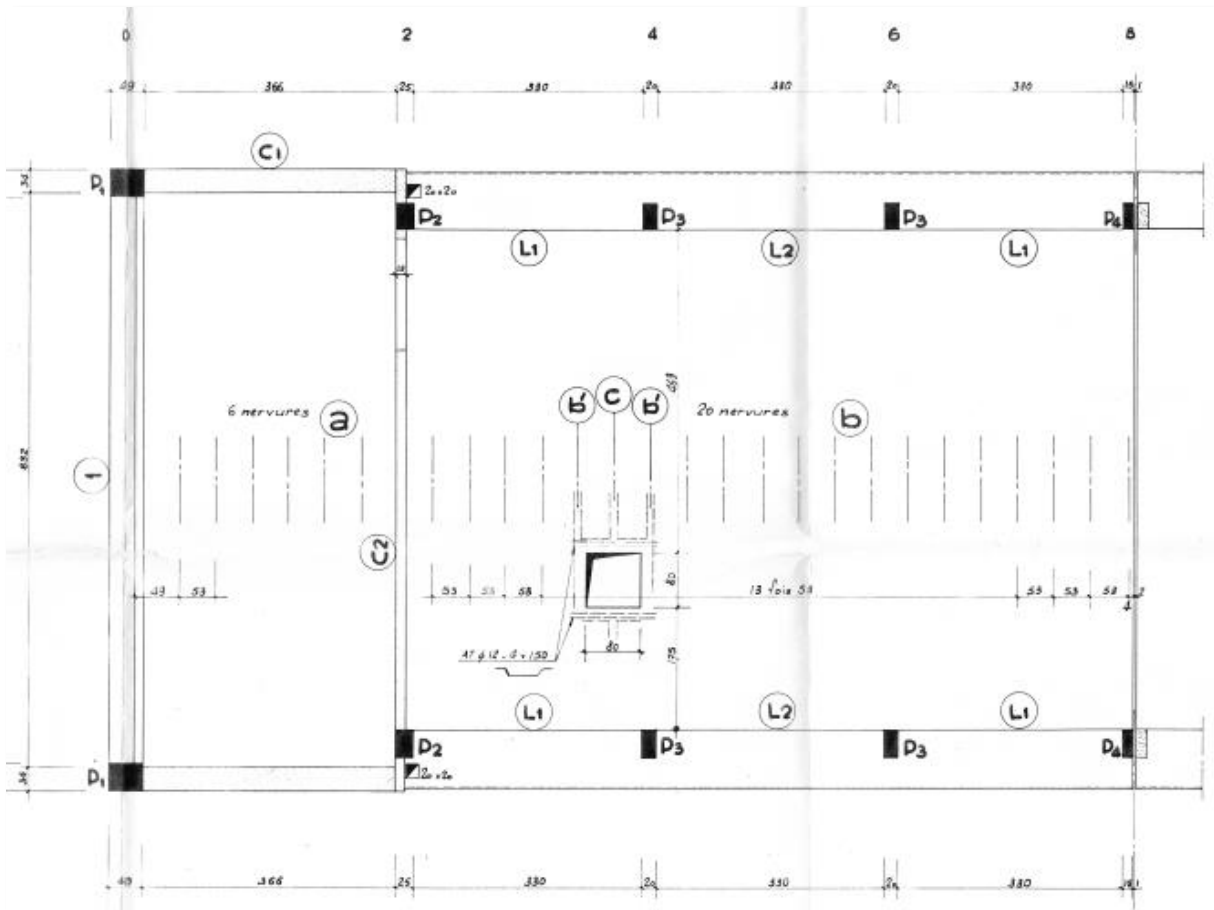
Vue en plan terrasse bloc 1, extrait BA132
